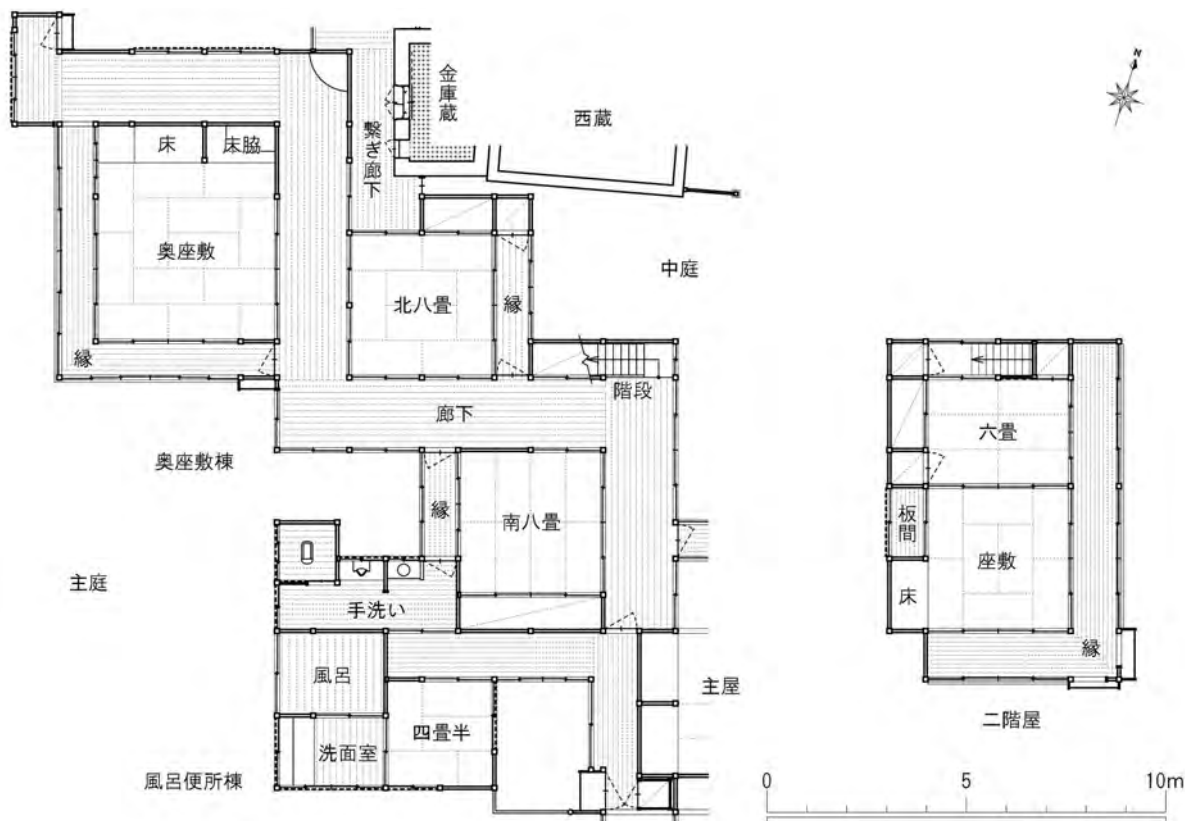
、奥座敷棟・風呂便所棟・二階屋 平面図（修理前）
